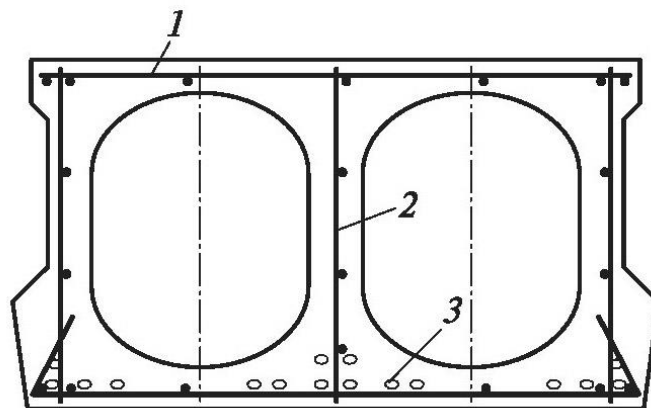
Армирование блока ненапрягаемой и напрягаемой арматурой:
